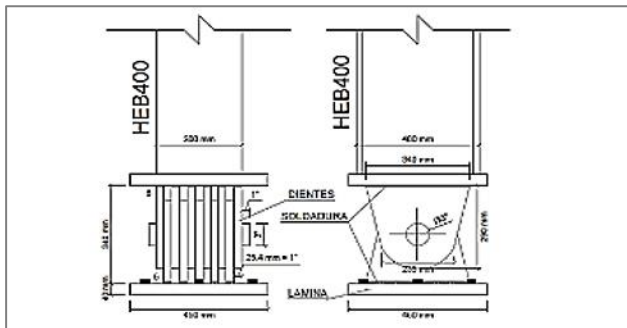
Esquema de conexión articulada ubicada en las columnas metálicas de cada ala del complejo
